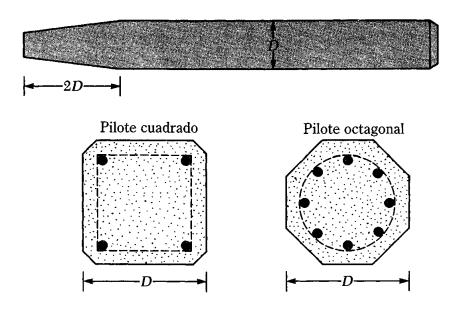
Pilotes prefabricados con refuerzo ordinario
